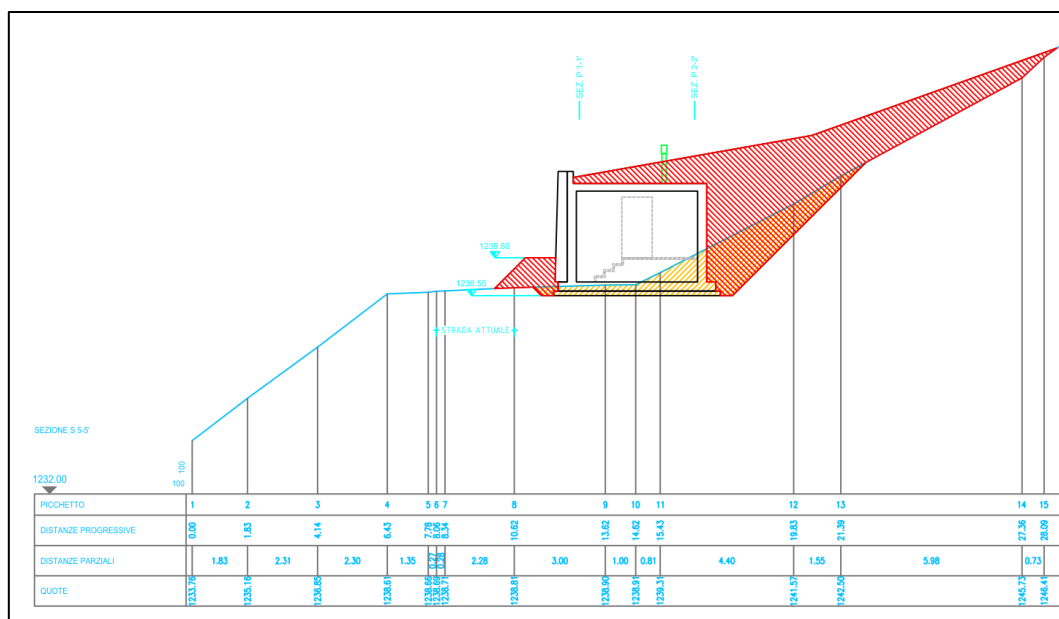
Sezione e apparati fondazionali nuova vasca Pocc.
